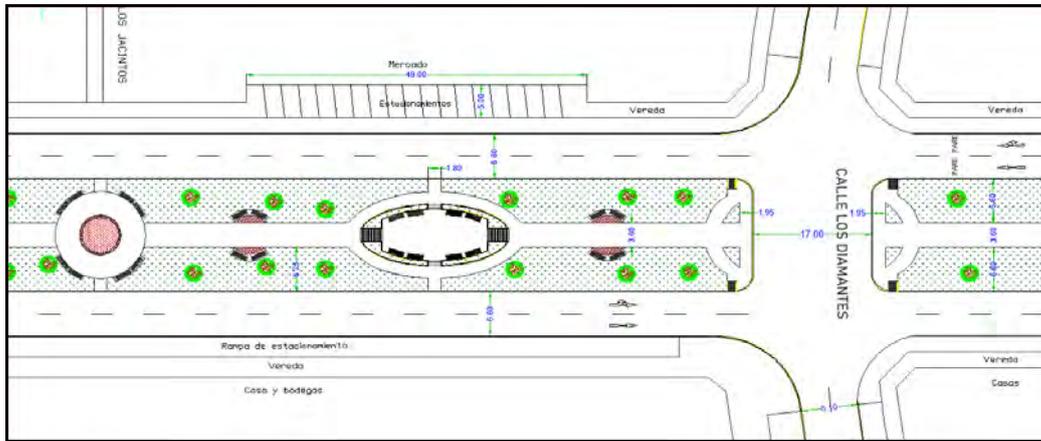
Situación actual Vista en Planta de la Calle Palermo.
